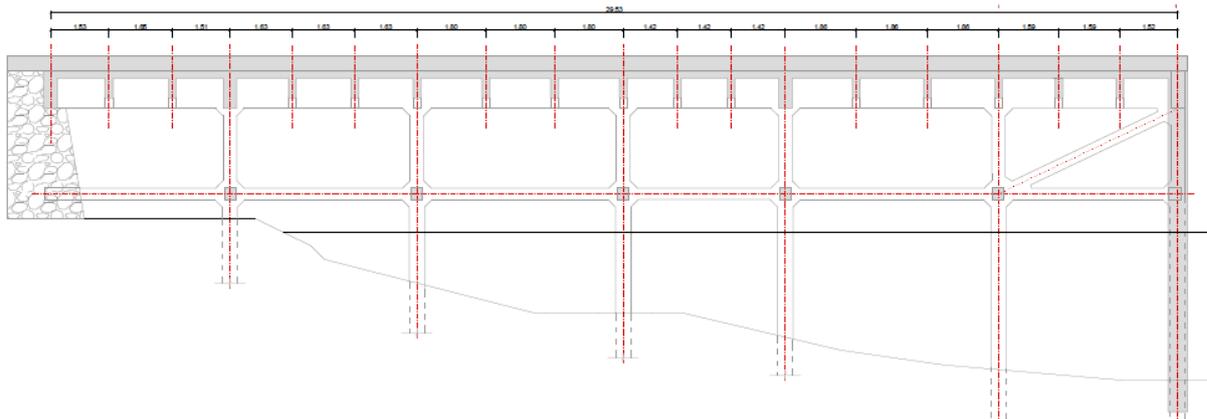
Vista de uno de los alzados de los pórticos del Muelle de Maura recogidos en el proyecto de Gutiérrez y Chamizo [16].
